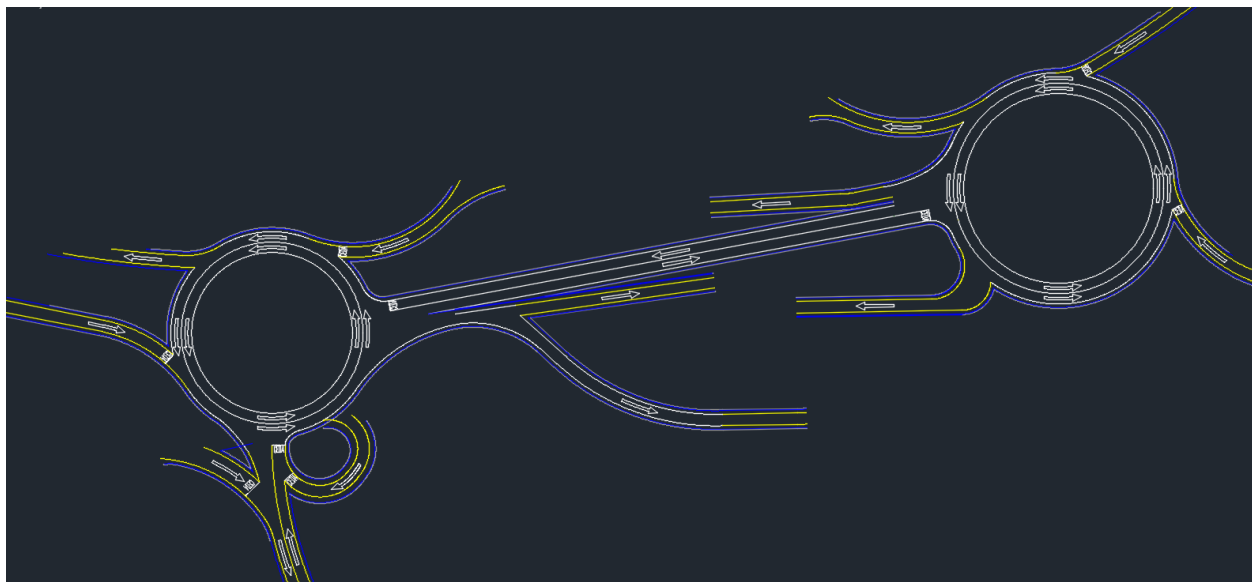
Vista en planta del diseño geométrico bajo el nivel actual del terreno.
